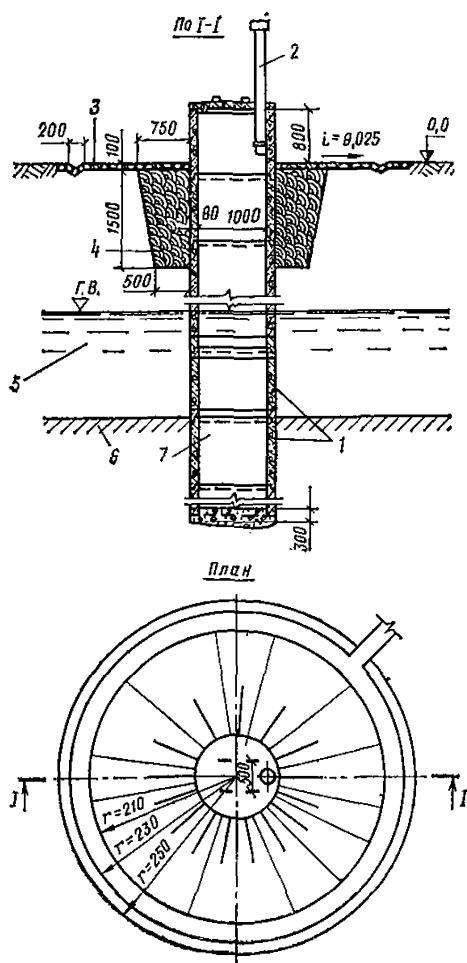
Конструкция совершенного шахтного колодца из сборных железобетонных колец
